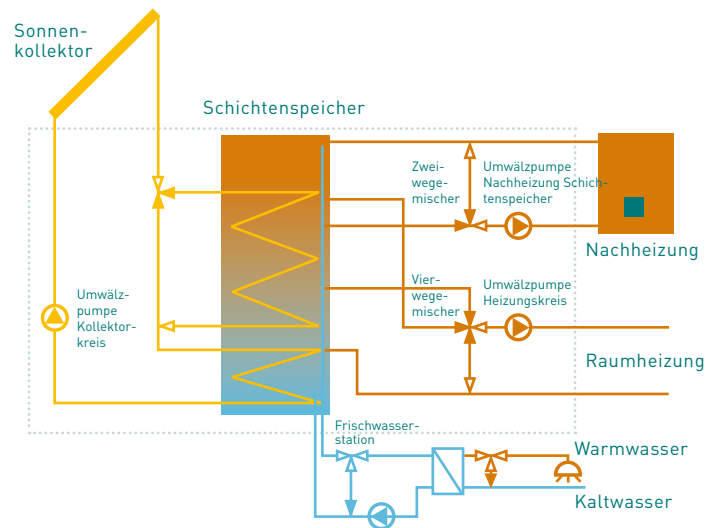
Hydraulikschema einer Heizungsanlage in einem Solarthermiehaus
